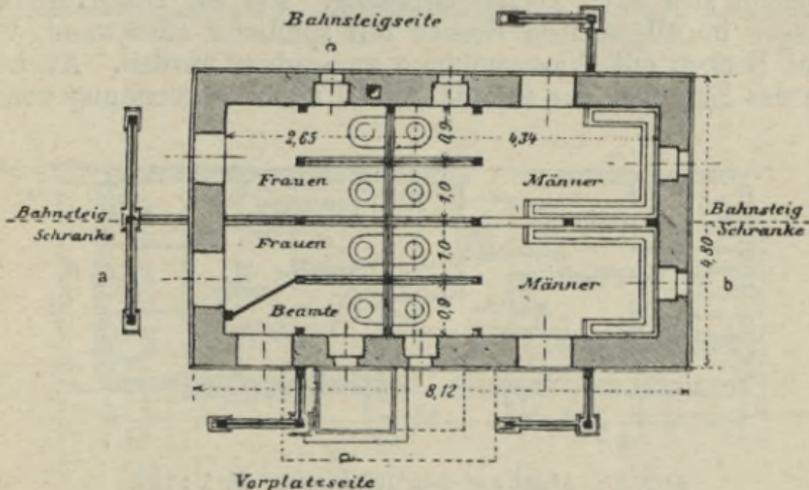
Abortgrundriß. M. rd. 1 : 180.
